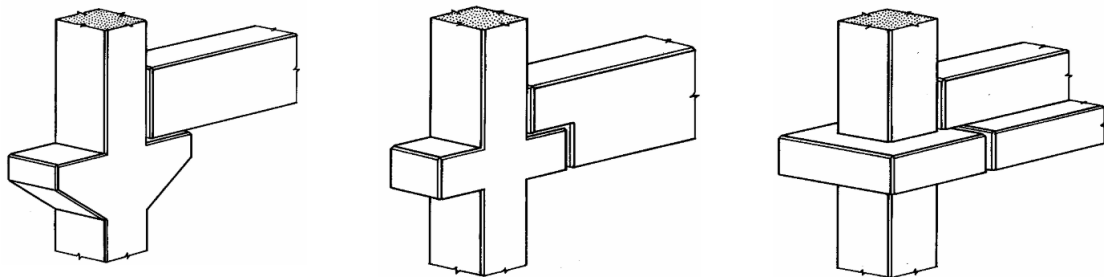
Formas de ligação viga-pilar em elementos de pré-fabricados betão (Van Acker [34]).
